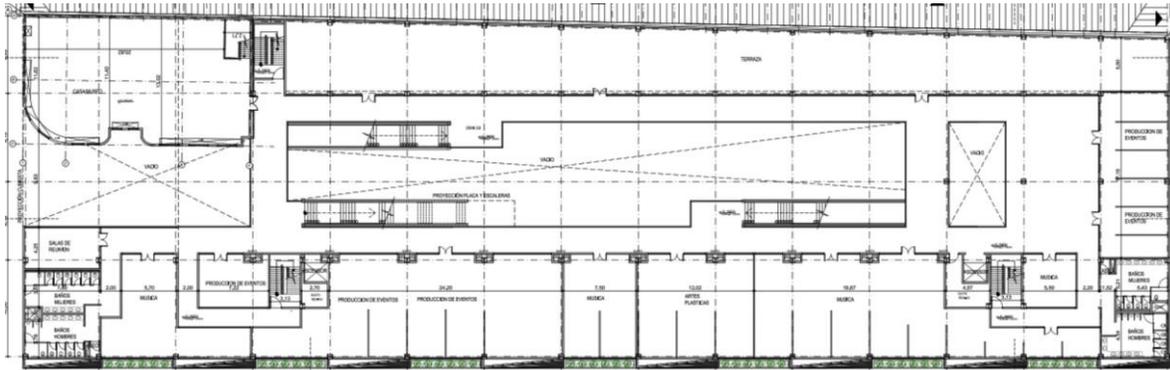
Planta cuarto piso – EDIFICIO CREATIVO
